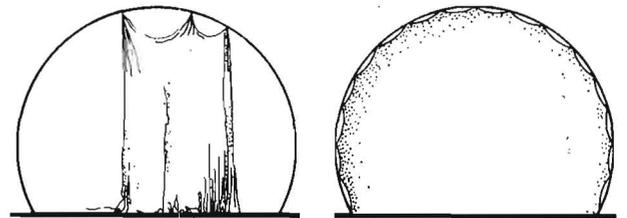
Montage der Dachhaut bei dem Kuppelprojekt Gorgast
